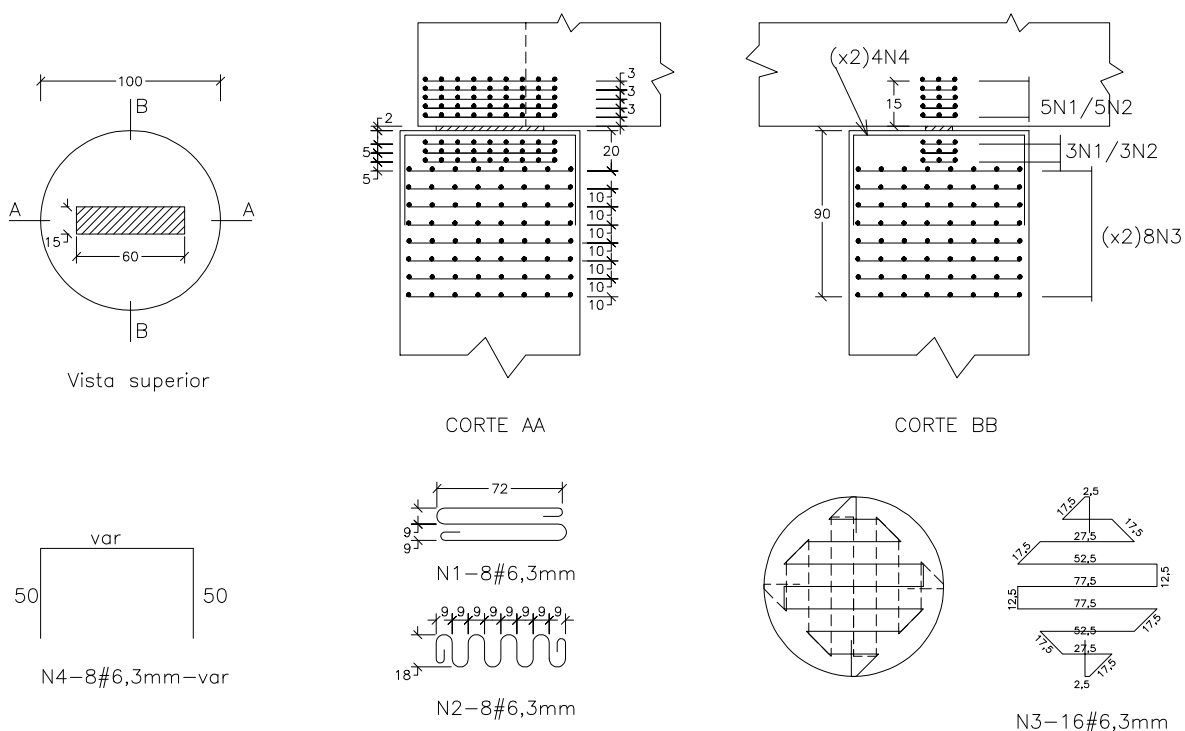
detalhe da armadura das rótulas do apoio (x8).
